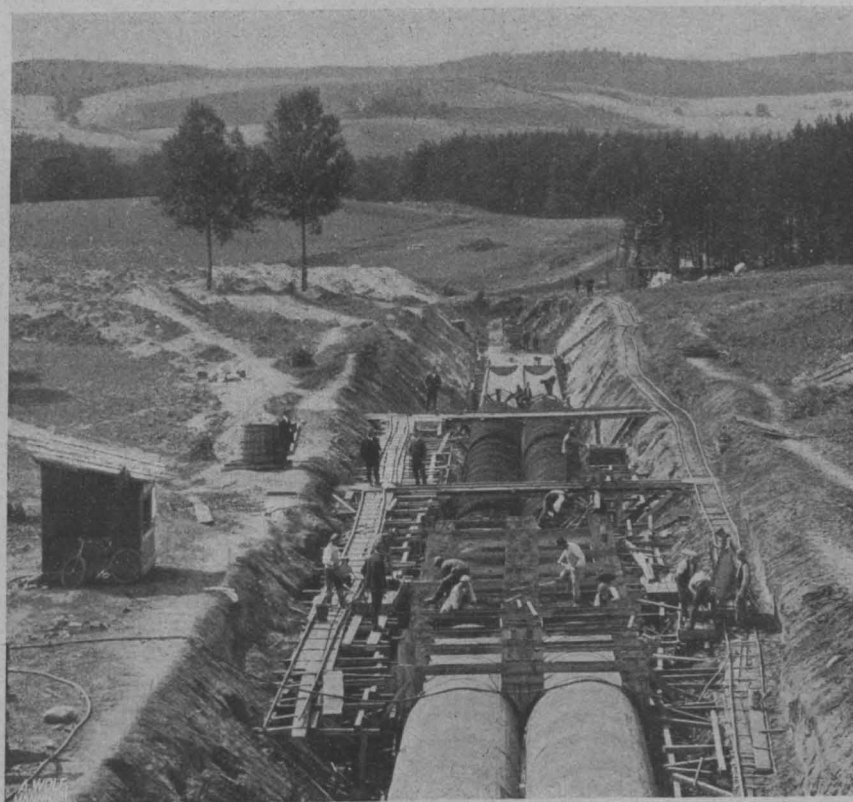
Betonieren der Eisenbeton-Druckrohrleitungen.
